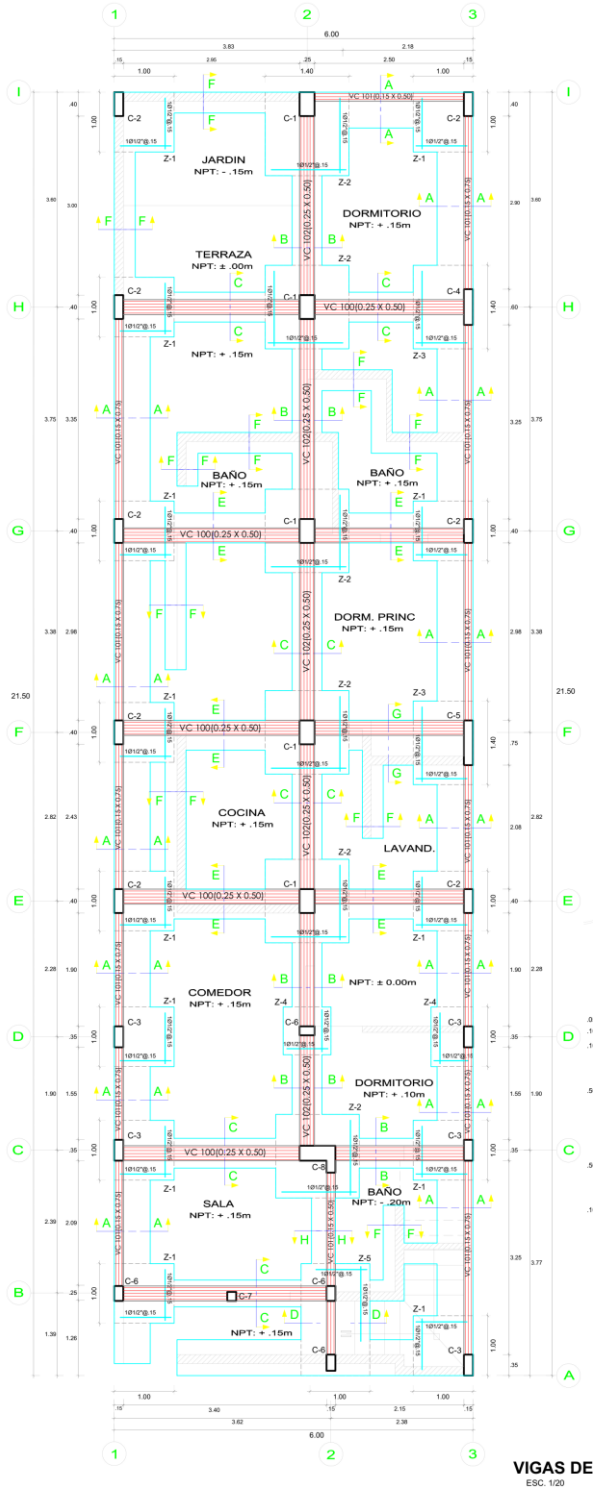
Plano de cimentaciones de estructura de Albañilería confinada
